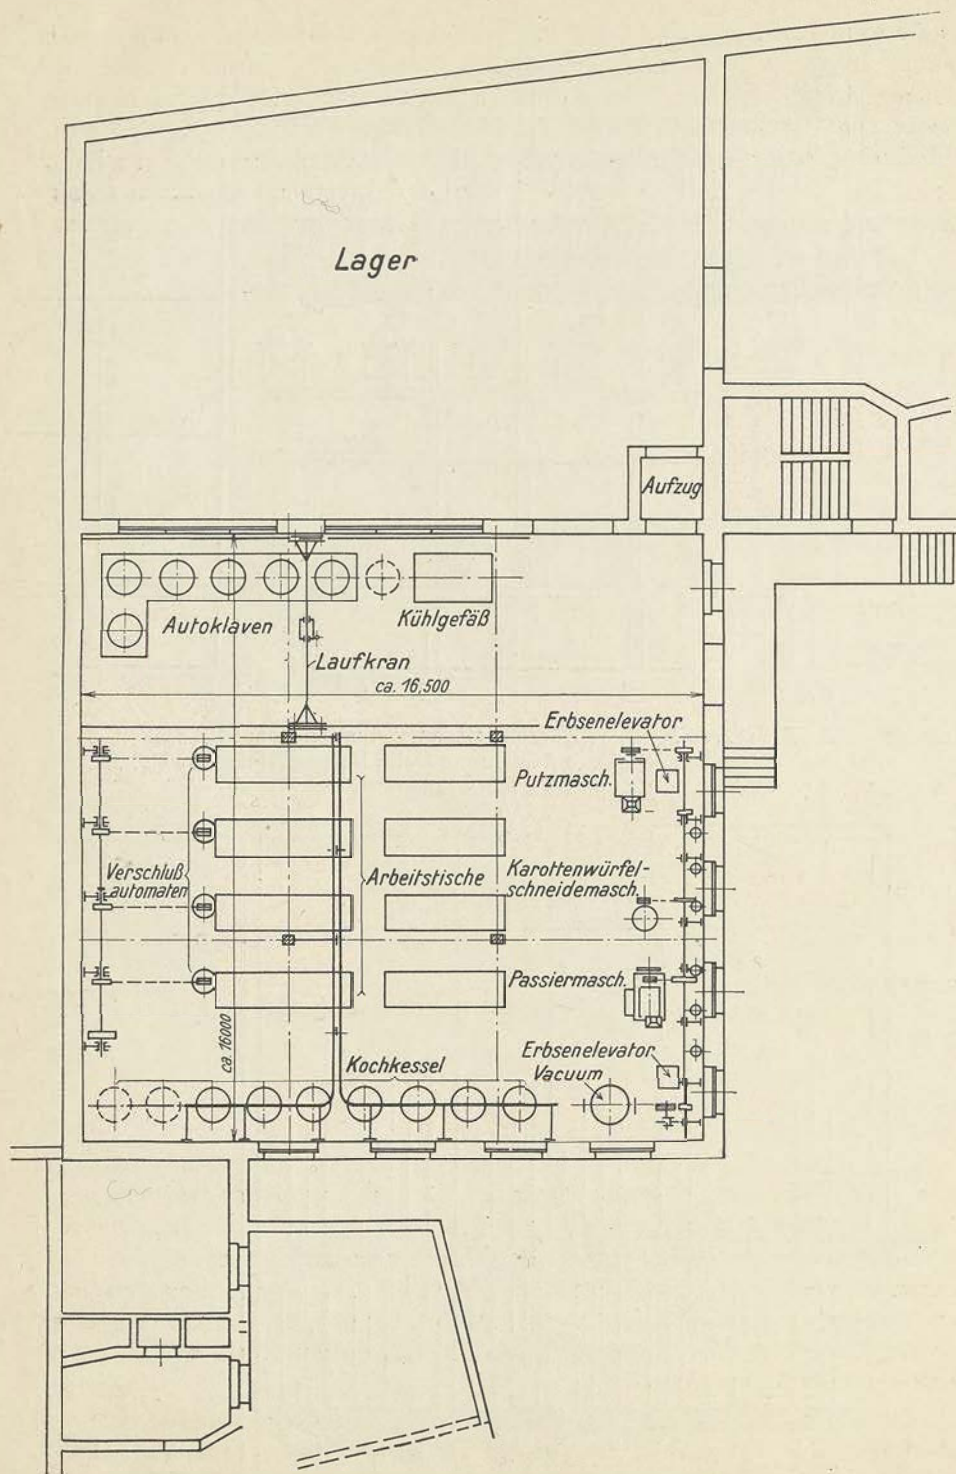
Grundriß der Erbsen-Spezialfabrik. (Erdgeschoß.)
